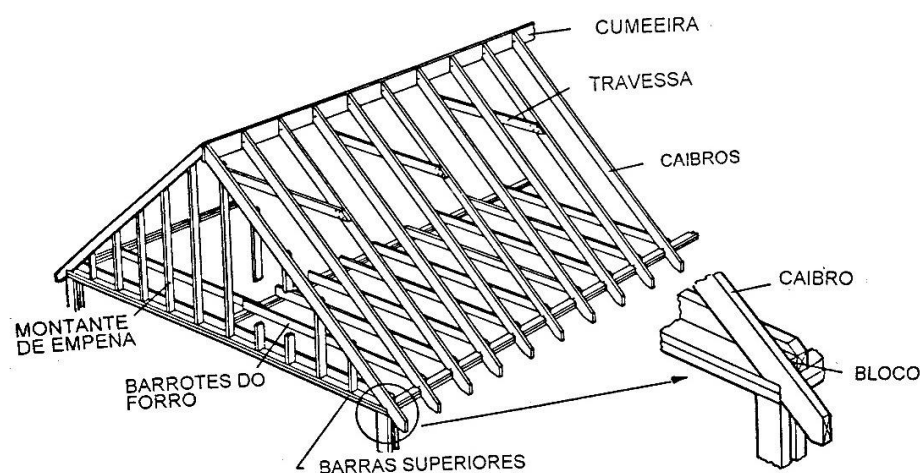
Detalhe construtivo de um telhado para o sistema plataforma
